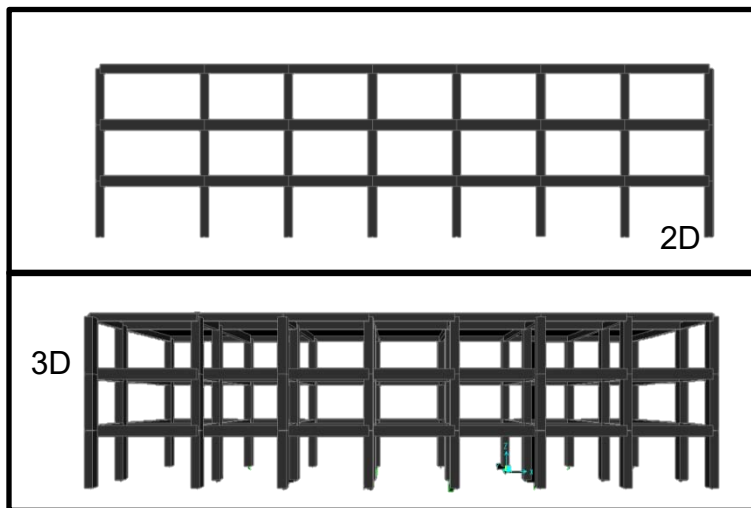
Estructura de concreto en dos y tres dimensiones
